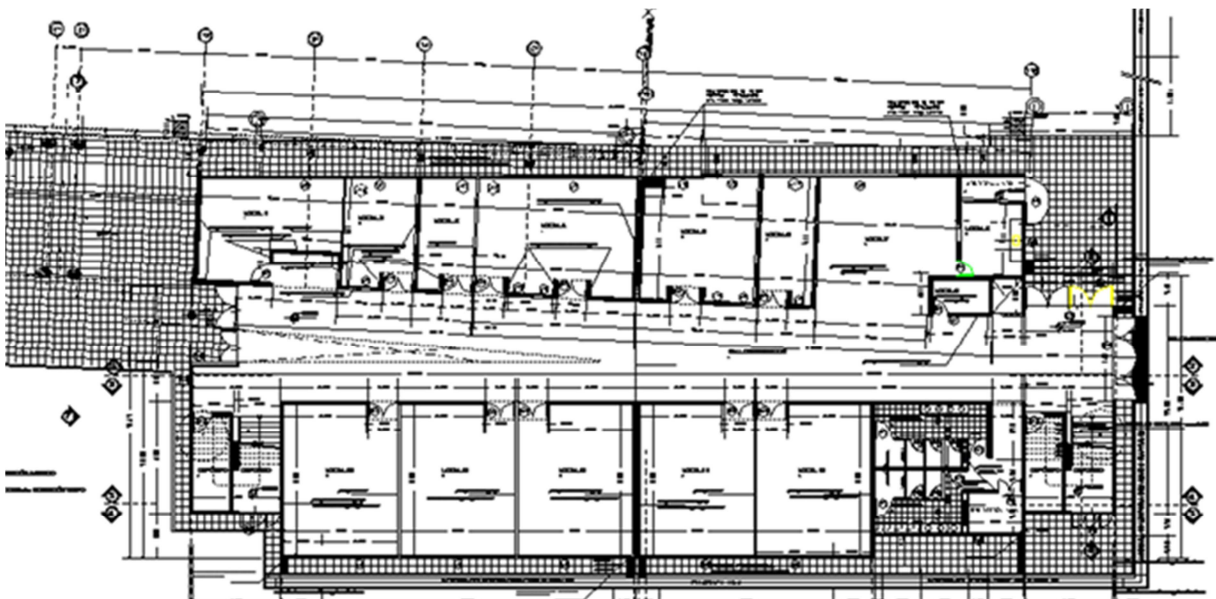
Planta Baja. Facultad de Lenguas. UNC.
